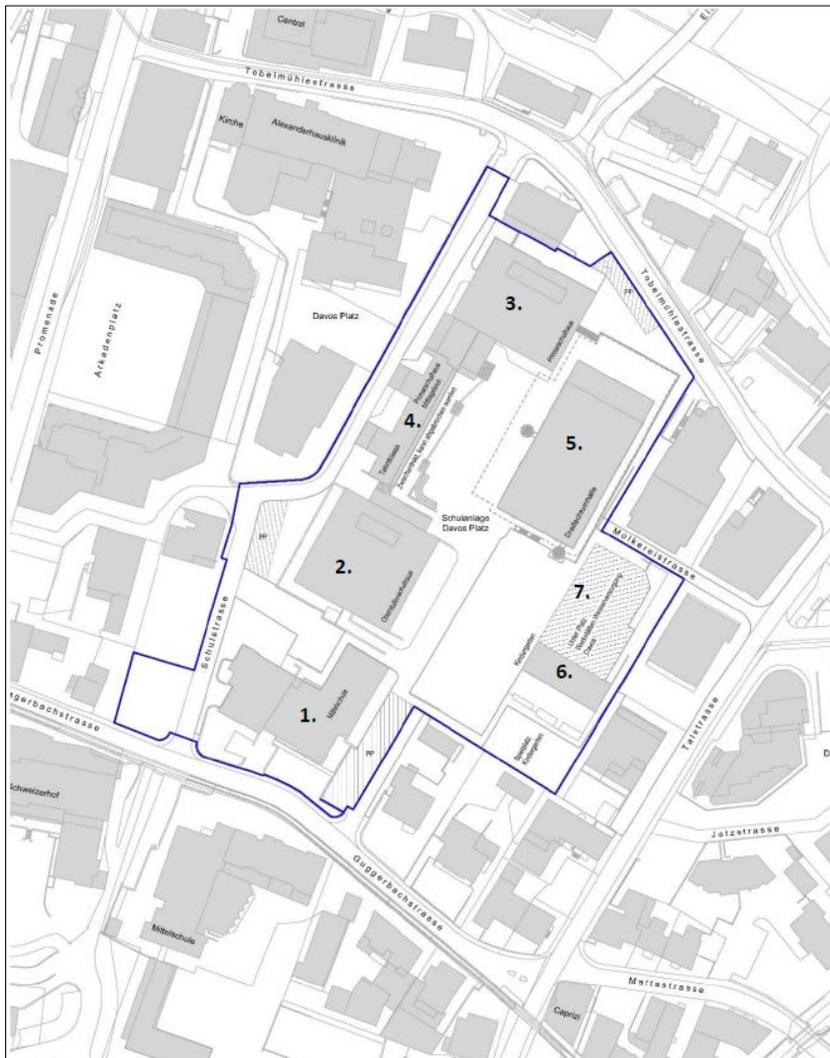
Übersicht Bestandesbauten Schulanlage Davos Platz, Parzelle 390
